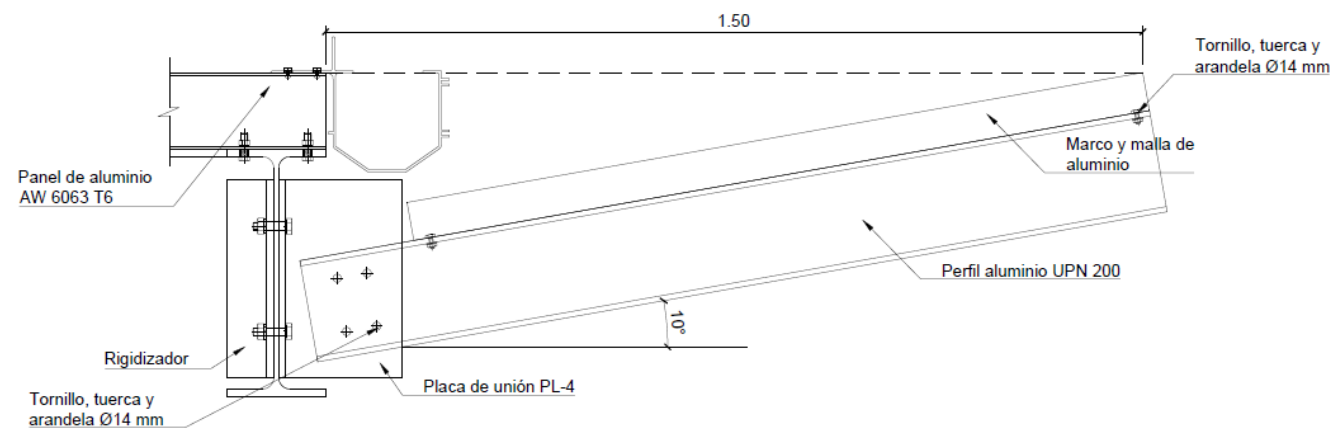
Detalle unión red perimetral de seguridad a estructura soporte. Fuente: Propia.
